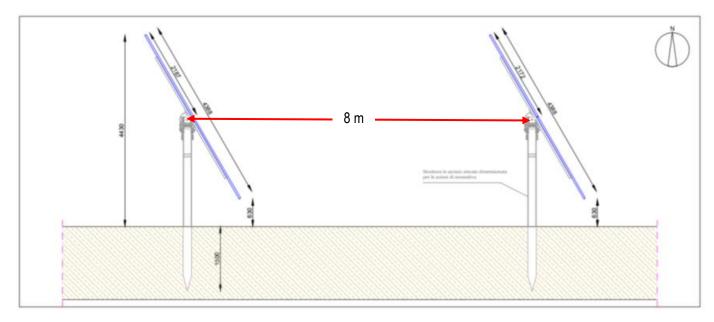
Sezione tipo delle strutture trackers previste dal progetto
